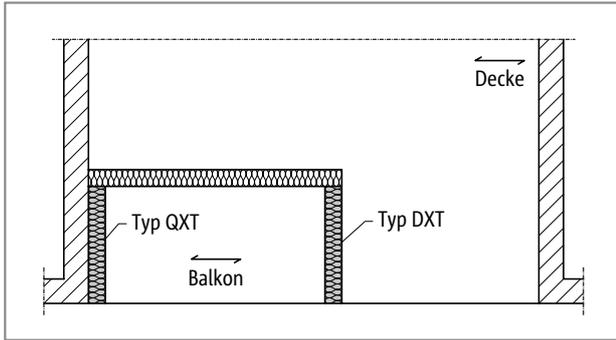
Schöck Isokorb® Typ DXT, QXT: Decke einachsrig gespannt
